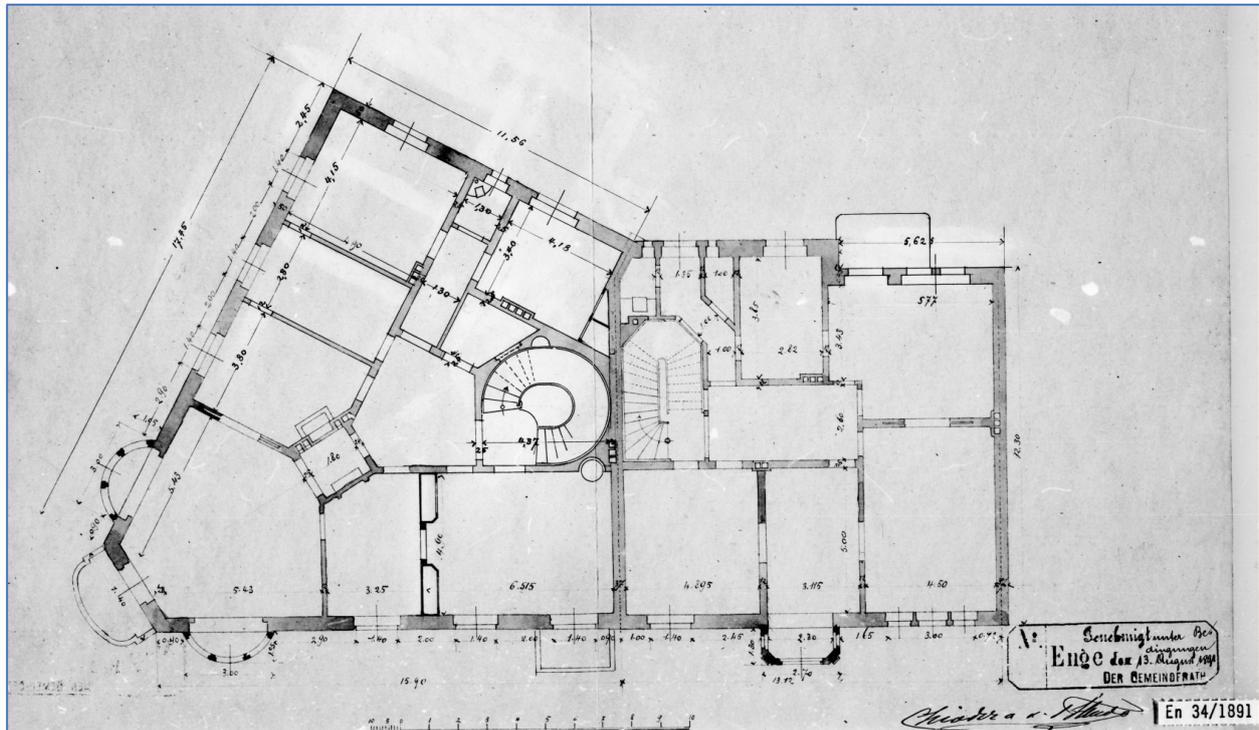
Grundriss des ersten und des zweiten Stockwerks des Bleicherwegs 37 und 39 gemäss Baubewilligung. In den letzten Jahrzehnten wurden einzelne Wände entfernt, um eine effizientere Büronutzung zu ermöglichen.
